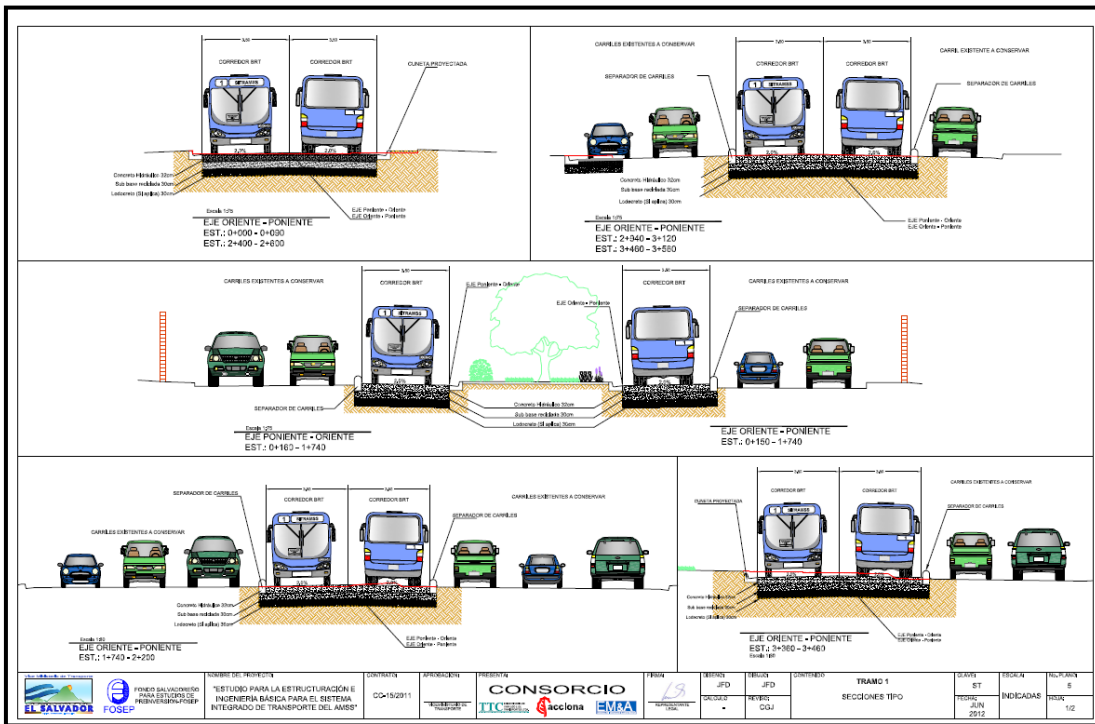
Secciones tipo en Tramo I durante las diversas etapas del recorrido Soyapango –FENADESAL
